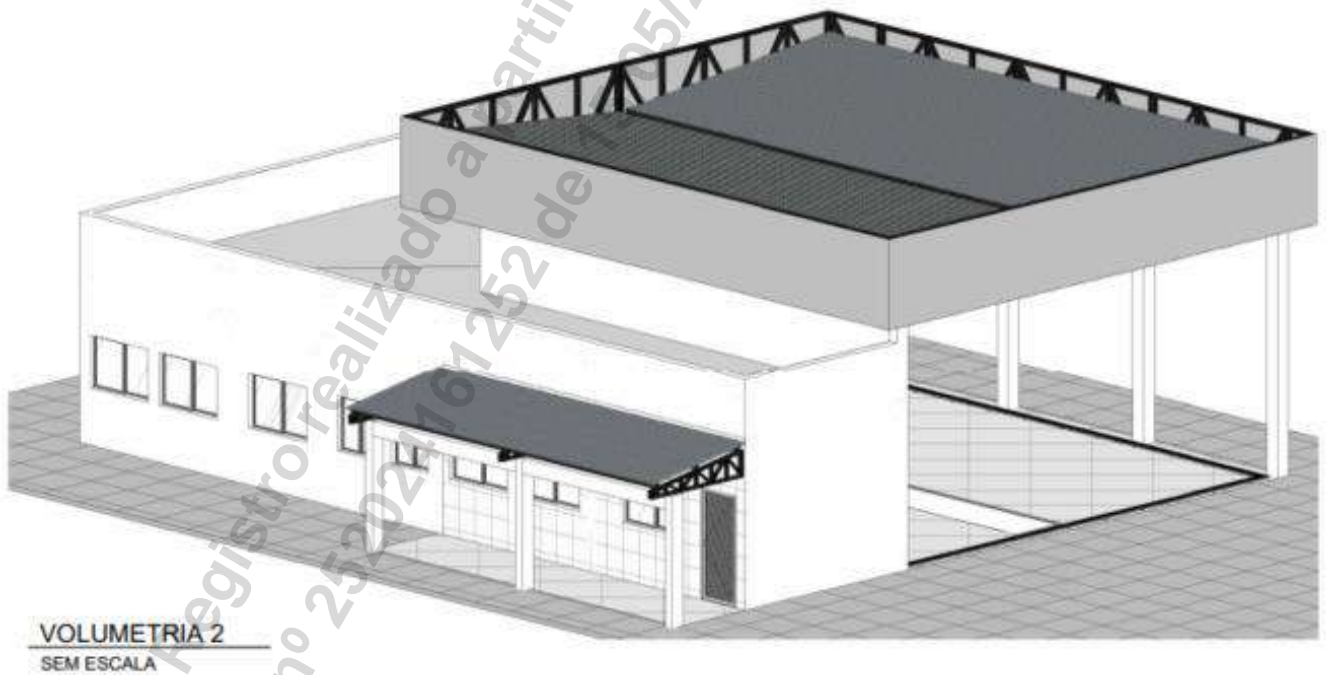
Imagem 3D – Área de Lavagem de Equipamentos (BIM)
